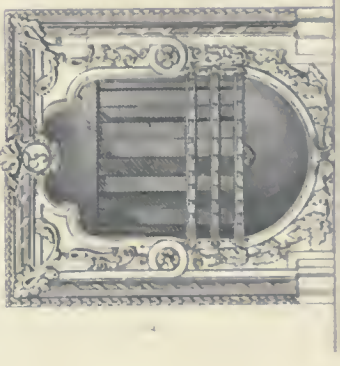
Elevation d'une cheminée circulaire. Fig. 8.
